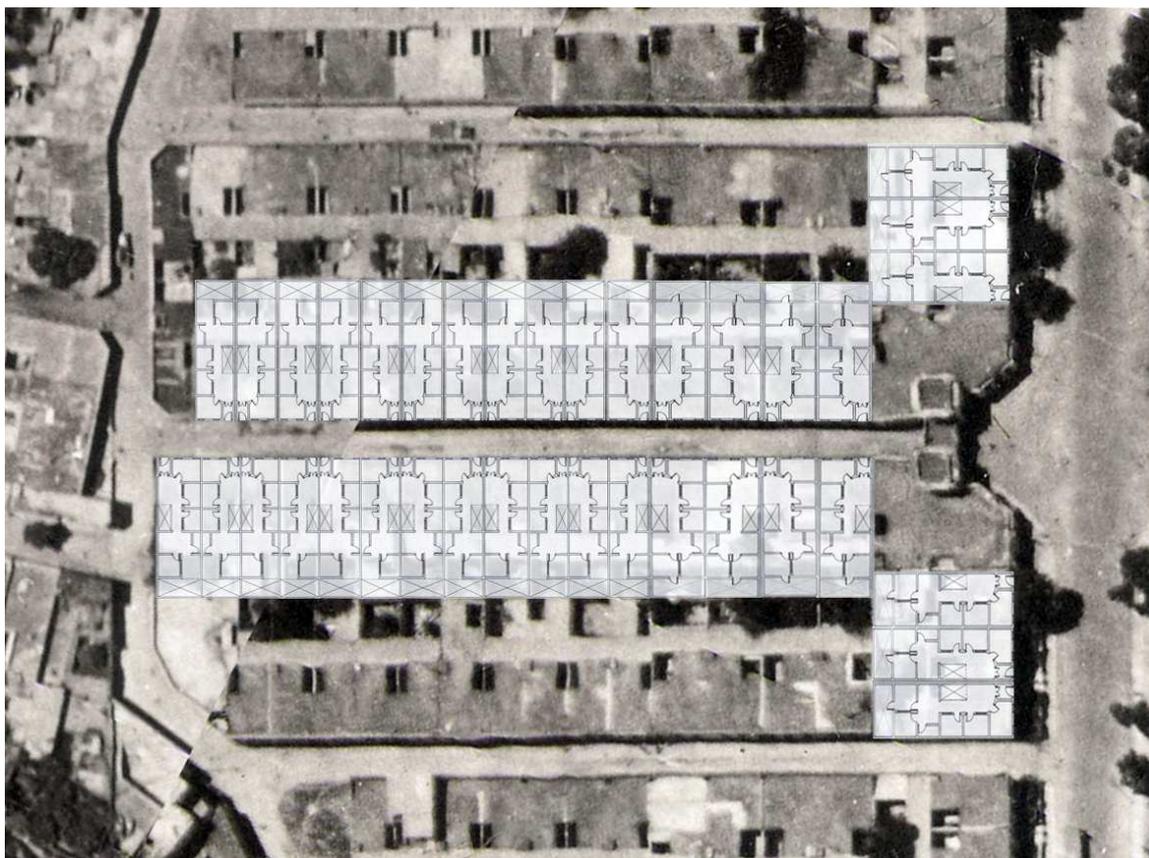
Manzana con plantas de viviendas Tipos A y B en San Agustín del Sur.
